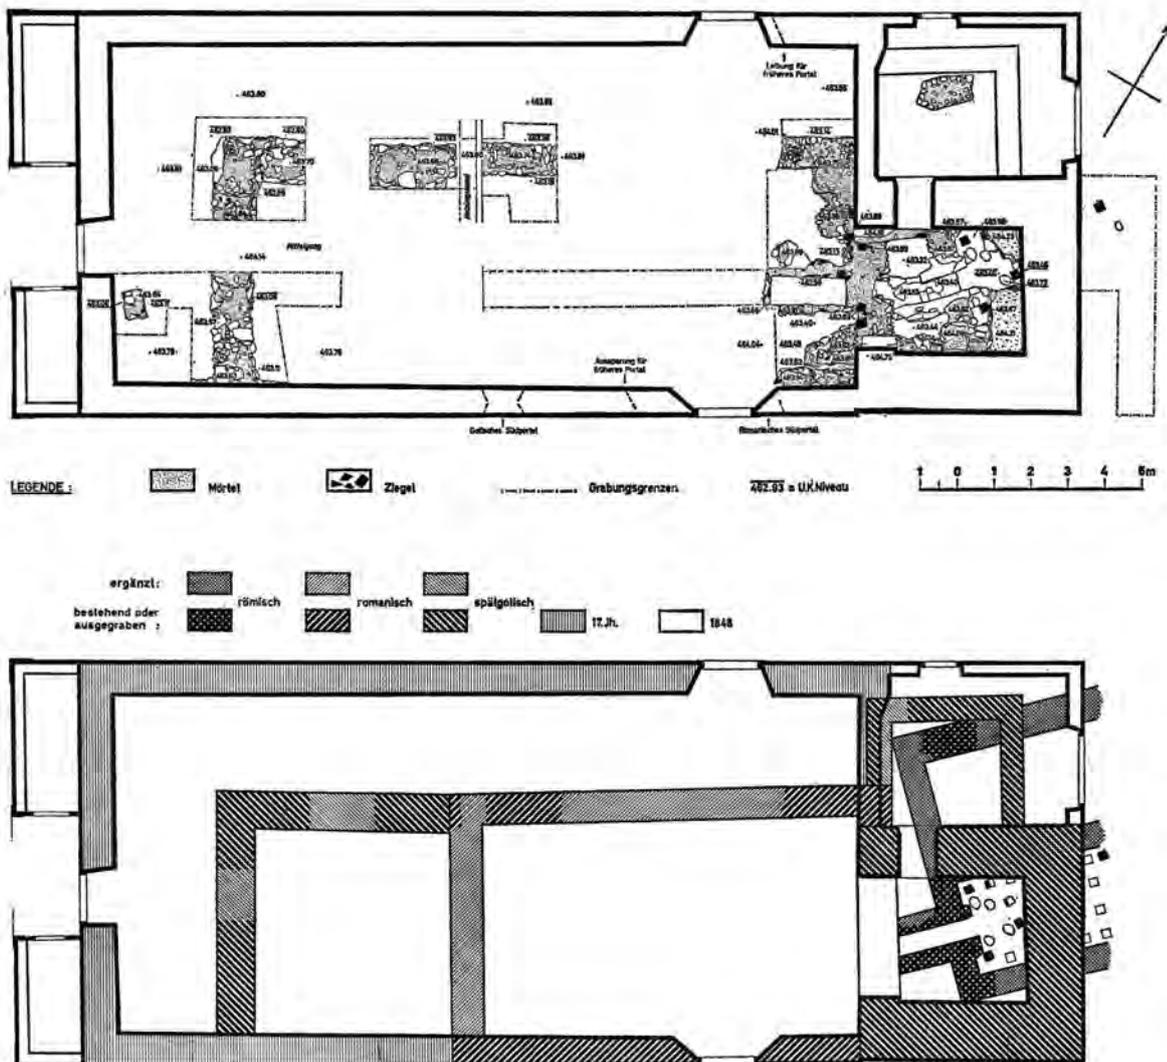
Bassersdorf ZH, Reformierte Kirche. Grabungsplan und Bauetappenplan. – 1:200.
